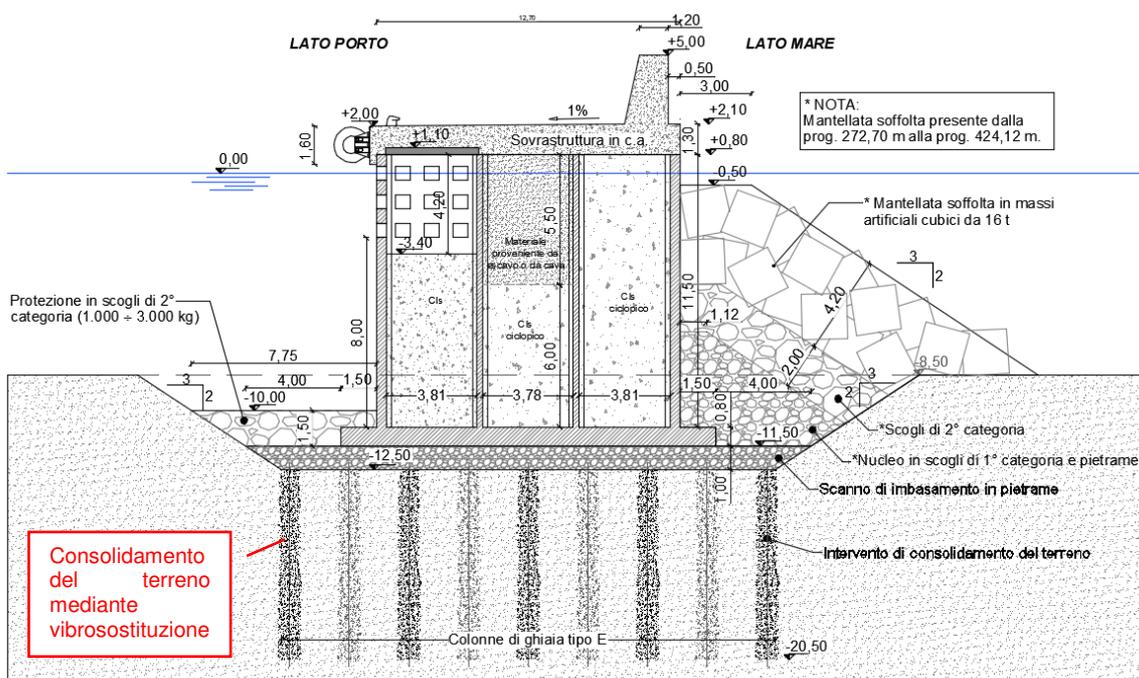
Progetto Esecutivo - Cassoni da n°15 a n°16 (protetti da gettata soffolta): sezione tipo
